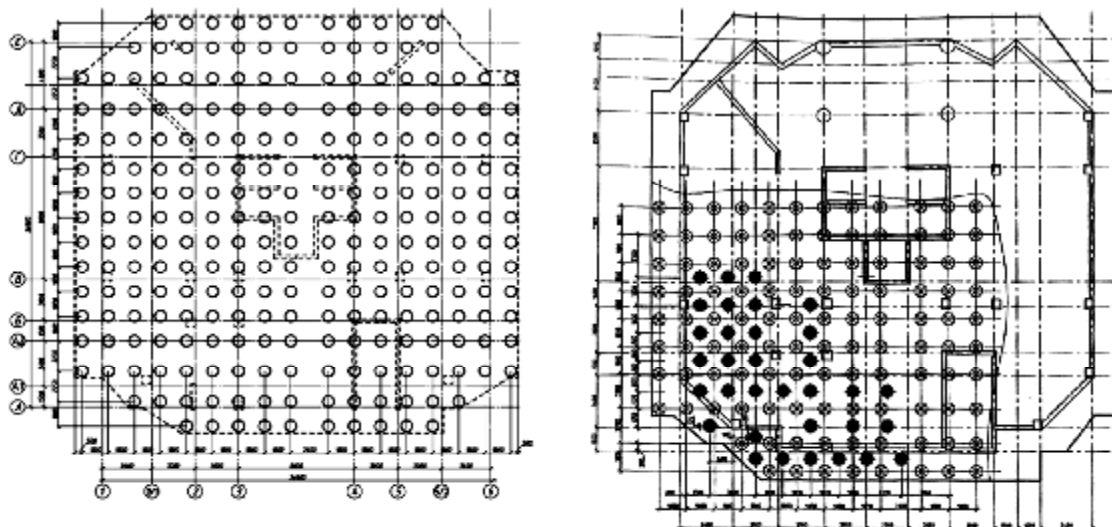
План свайного поля согласно проектному решению и схема усиления грунтоцементными сваями (иллюстрация авторов)
